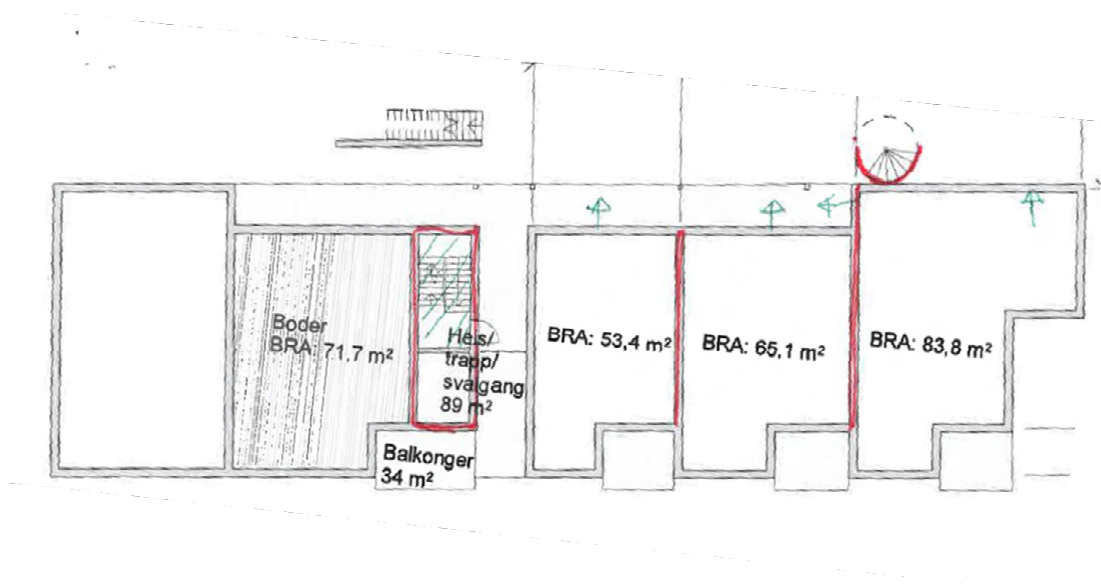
Plan kjeller. Rød strek angir krav til branncellebegrensende konstruksjon
